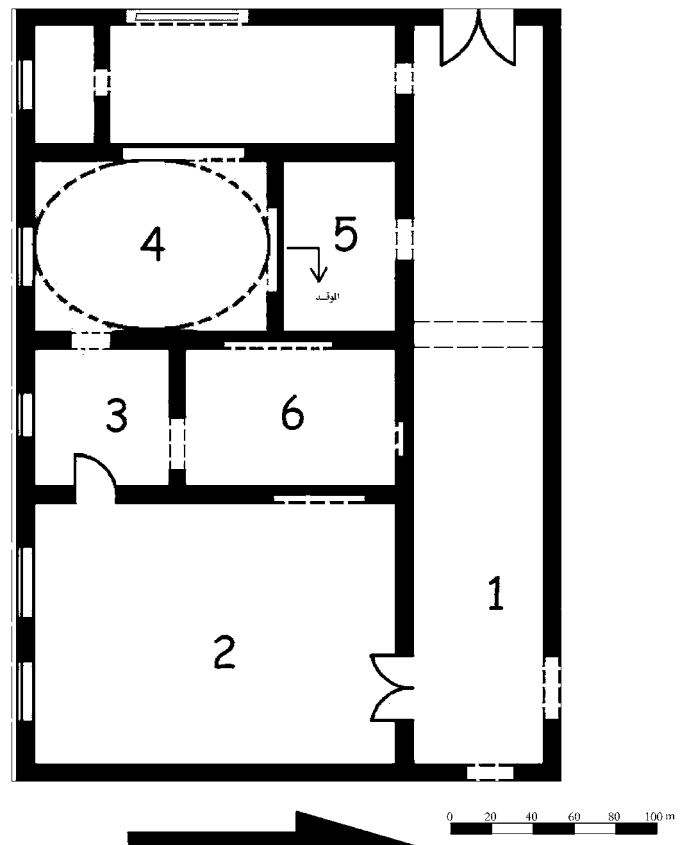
مسقط أفقي للطابق الأول لخان المطان بالطائف. (عمل الباحث والإستفادة من: غاويه وآخرون، الطائف التطور والبنية، شكل ٣، ص ١٢١).
